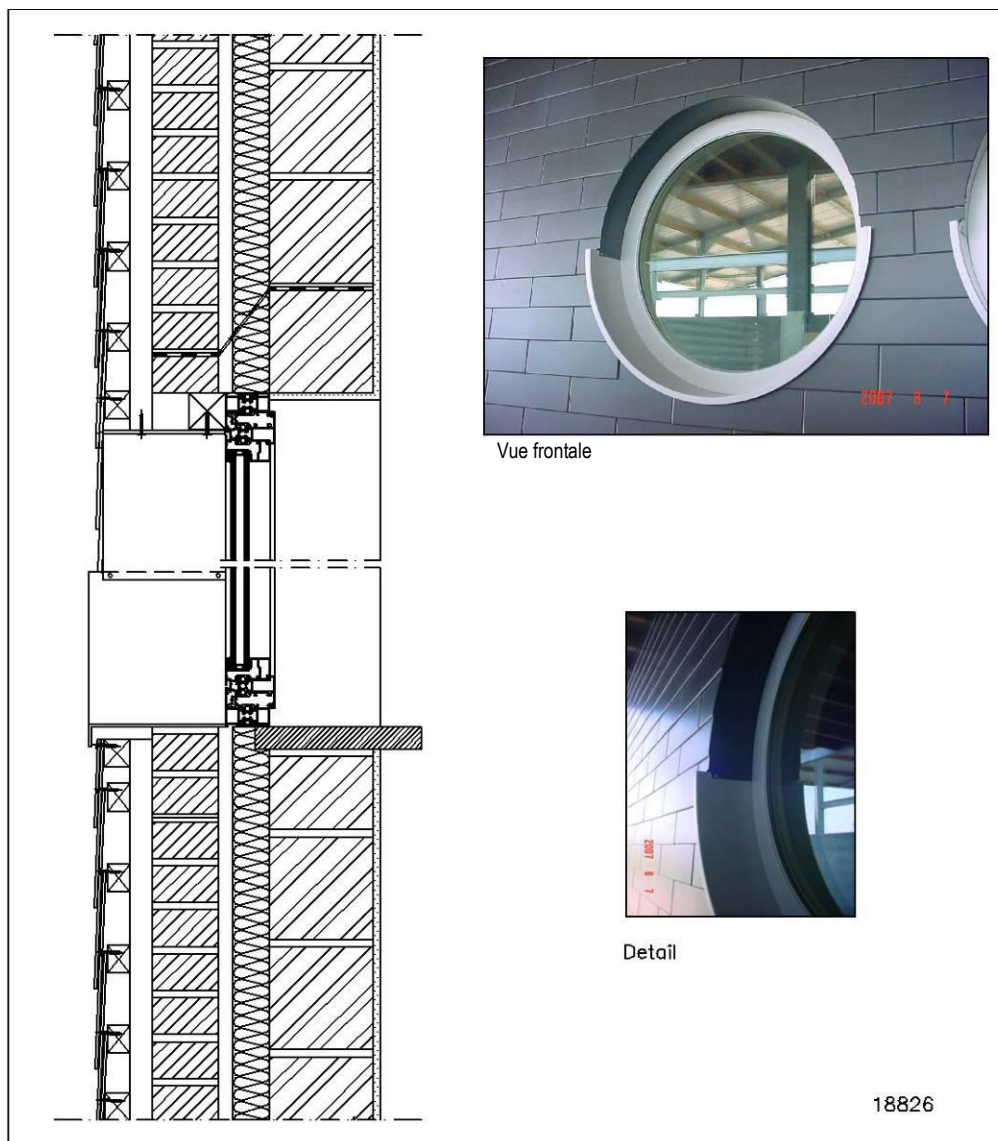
Exemple d'une finition avec une fenêtre en retrait – coupe verticale
